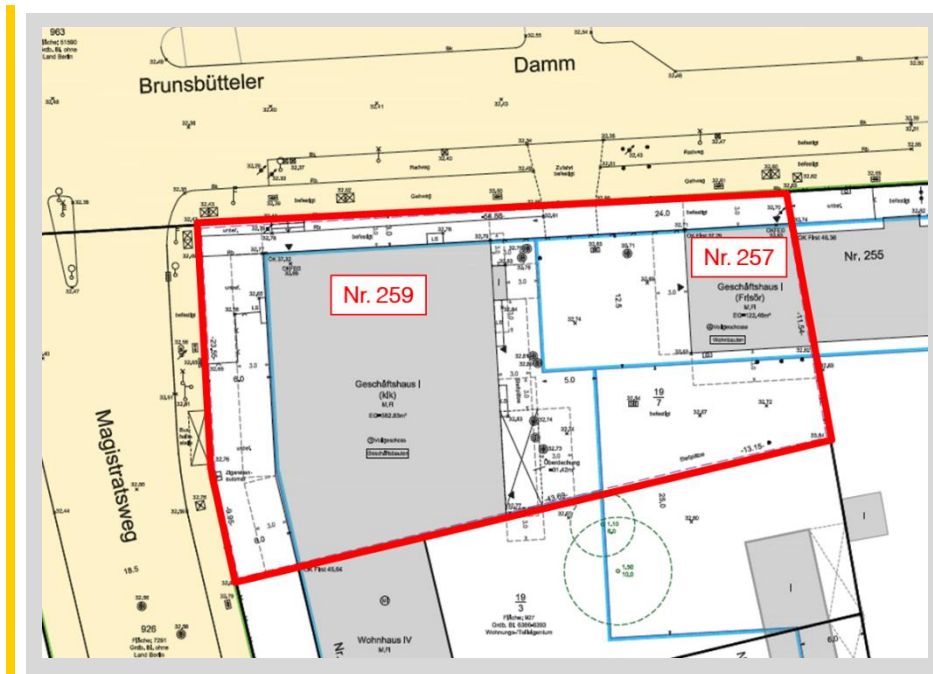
Grundstück mit Bestandsgebäuden¹
